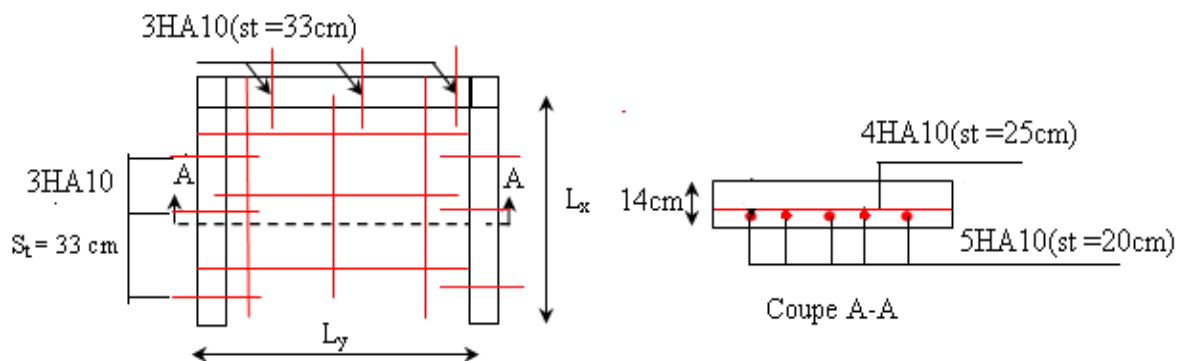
Schéma de ferrailage de la dalle D2, D5.
